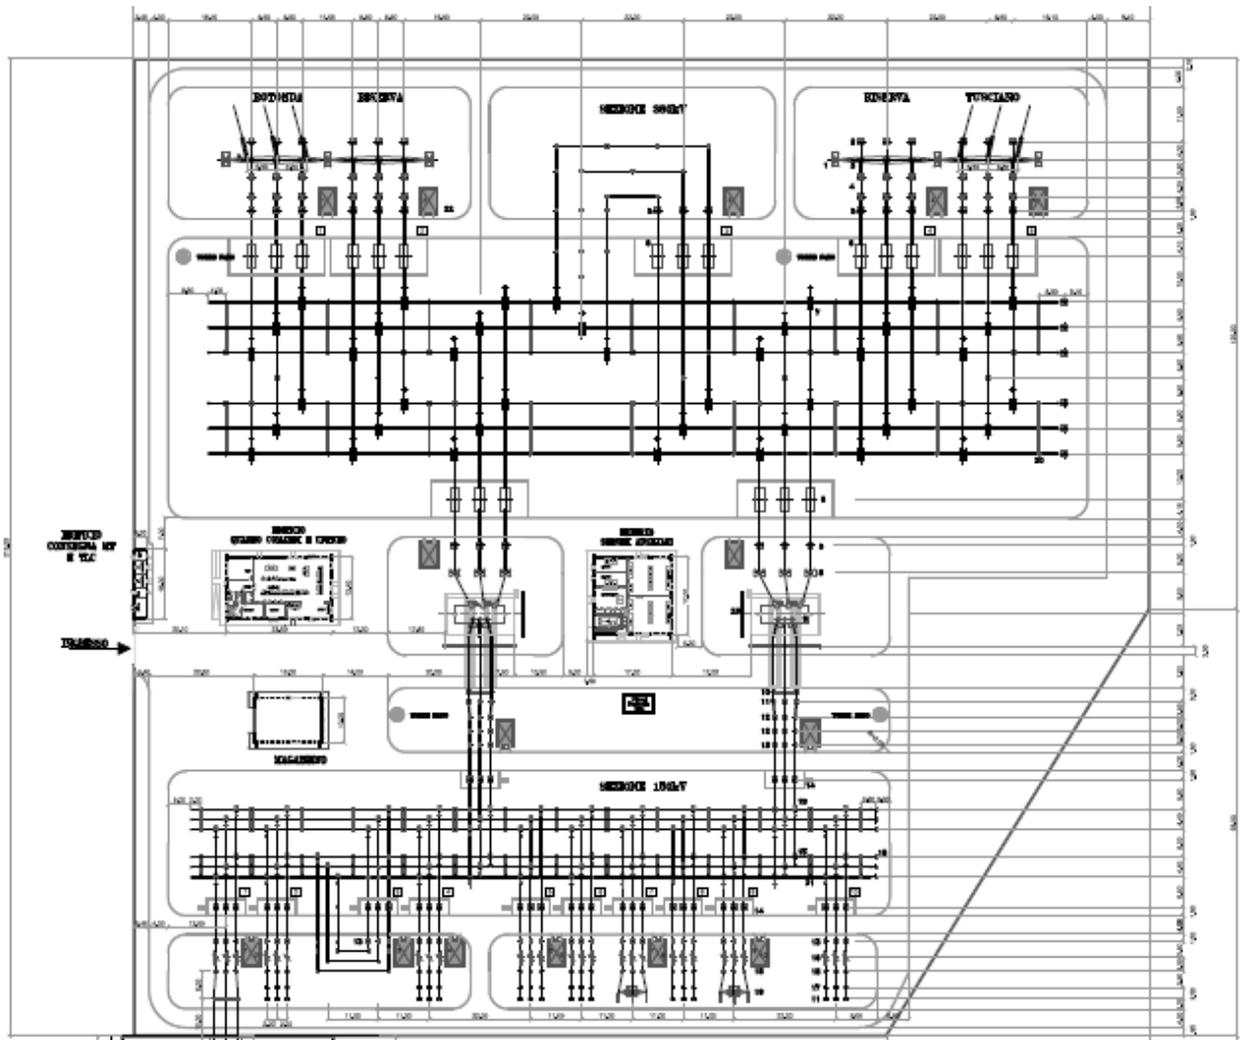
Planimetria elettromeccanica generale – Progetto originario
